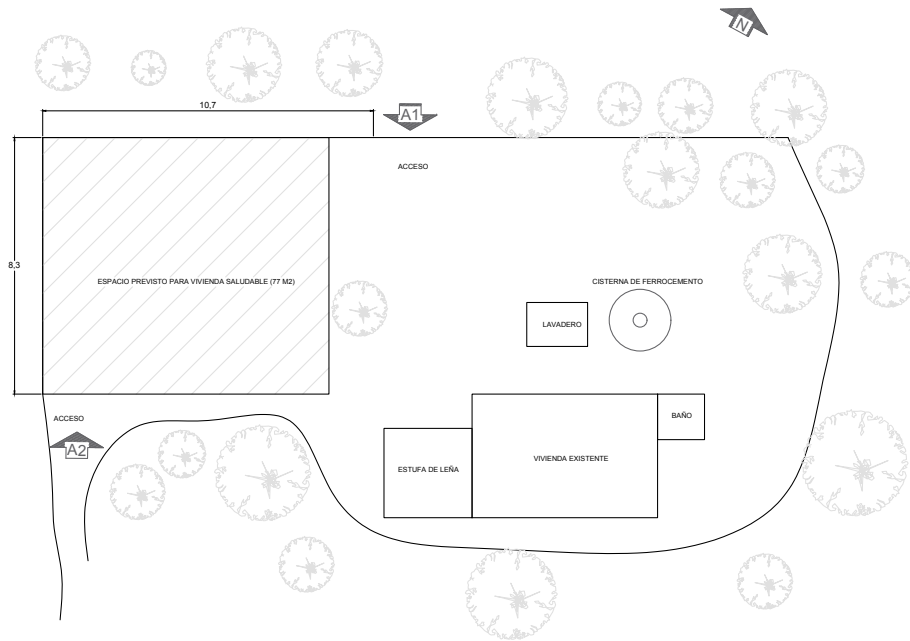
Planta de espacio previsto sin escala (fuente: Elaboración propia)
